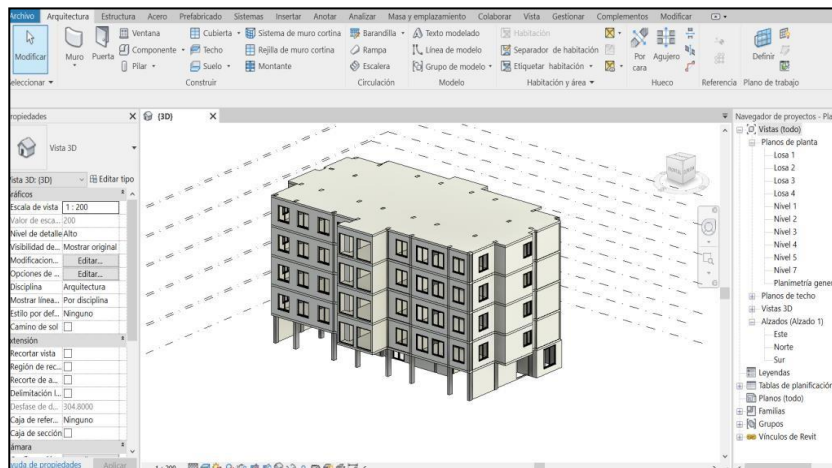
Modelo 3D de Torre B arquitectónicamente
